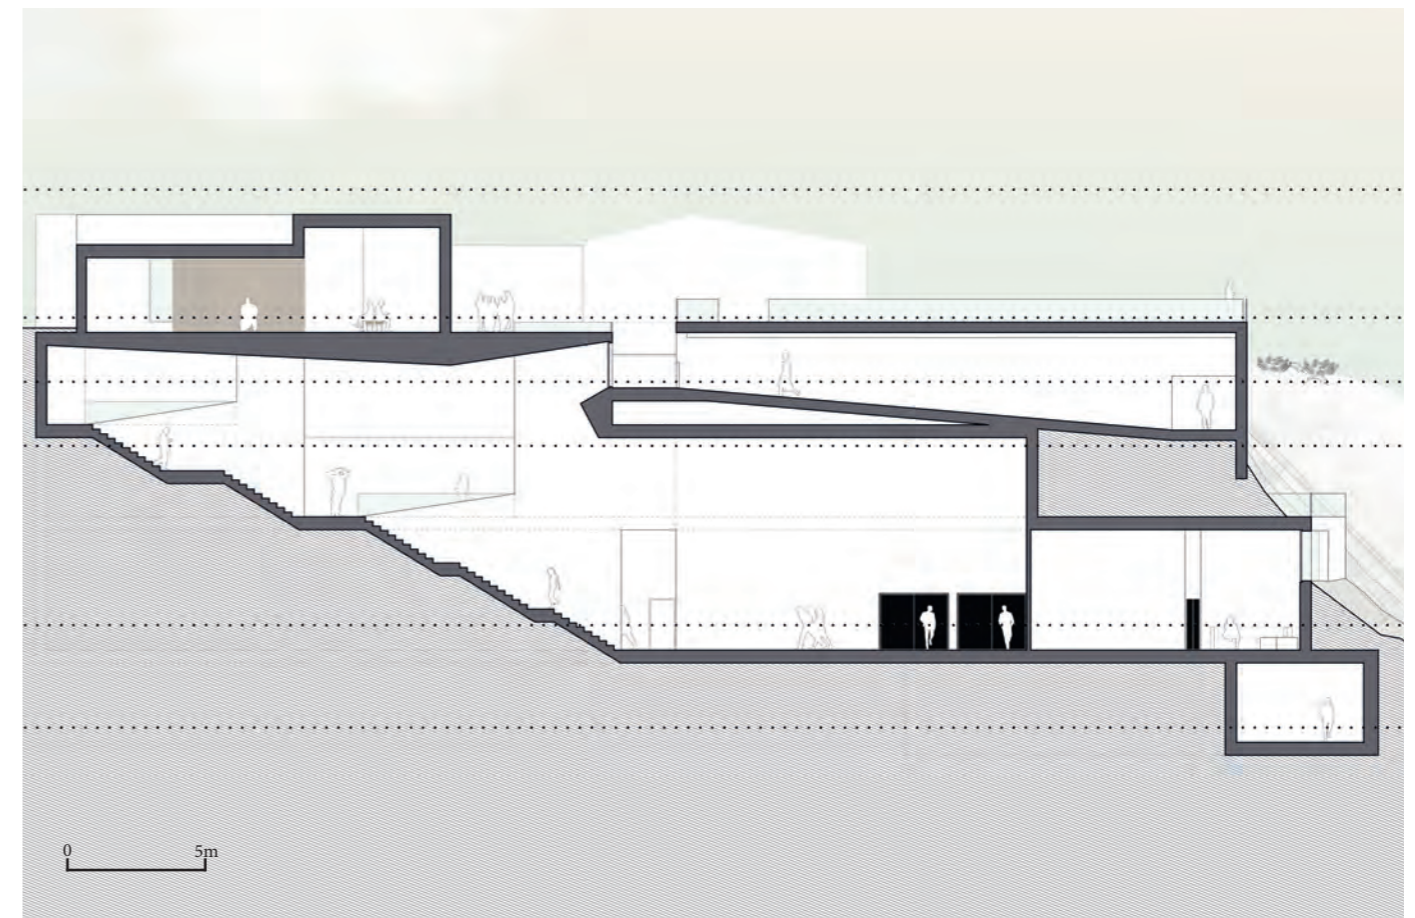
PROPOSTA - Corte longitudinal E - escadaria norte e rampa exterior (legenda em anexo)
